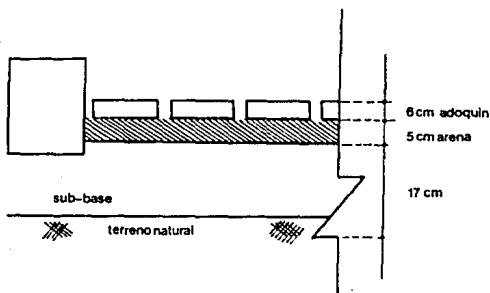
VISTA DE LA SECCION TRANSVERSAL TIPICA DEL PAVIMENTO PARA EL CONJUNTO CONDOMINAL FUENTES DE ATLACOMULCO.
